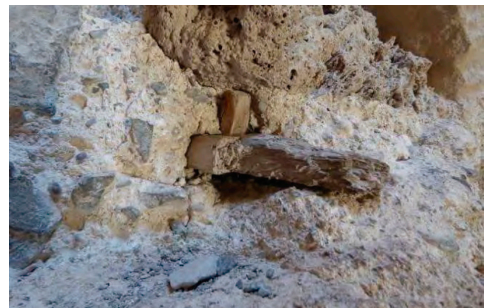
Detalle de una media aguja fijada en la fábrica con un pasador en la parte interior del muro encontrado en el interior del muro meridional (Vegas & Mileto, 2018)
